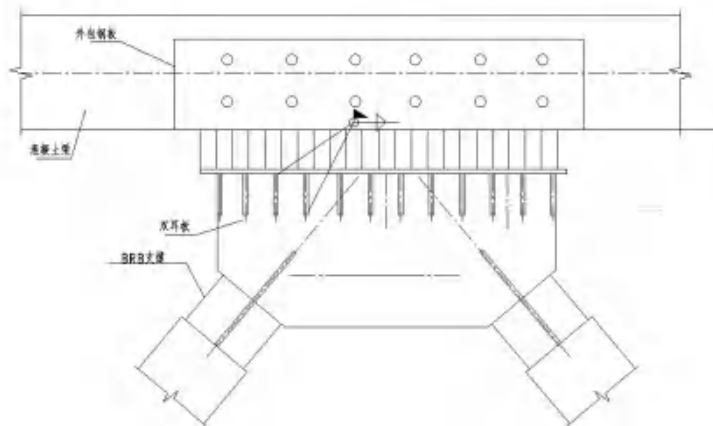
58 既有混凝土结构中 BRB 连接节点（人字形支撑顶部）
